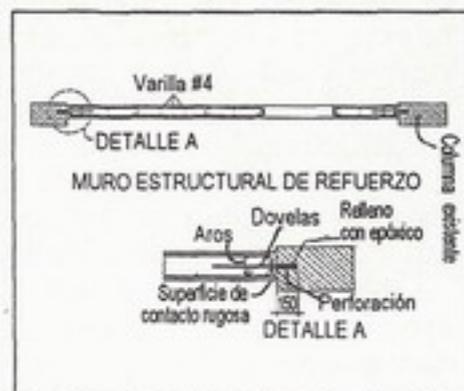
Conectores uniendo muros estructurales nuevos a las columnas existentes. Refuerzo de confinamiento adicional es colocado en los extremos del muro.
